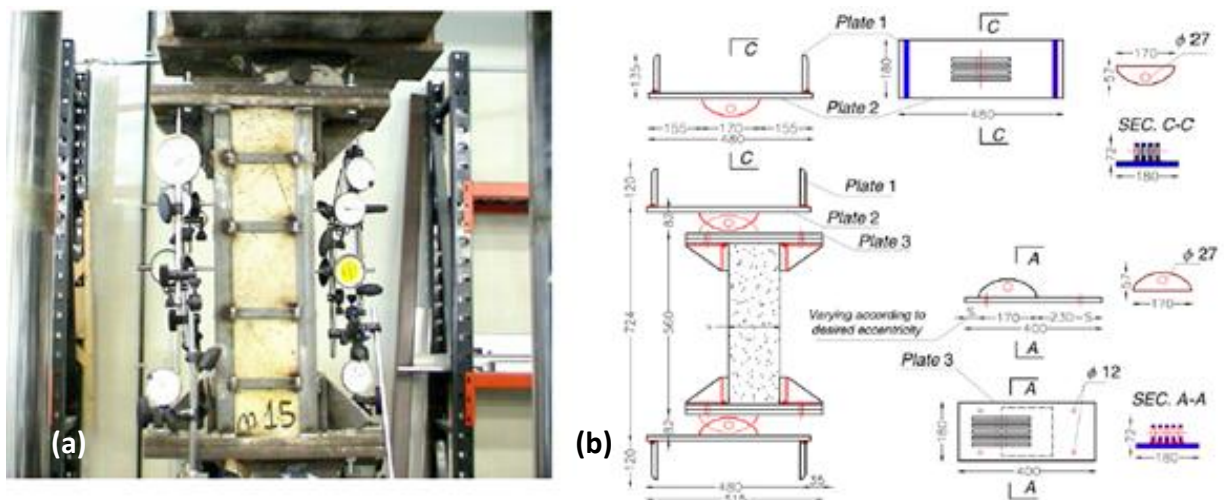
Ensayos desarrollados por Montuori y Piluso (2009). a) vista un ensayo; b) esquema de los elementos empleados en los ensayos
